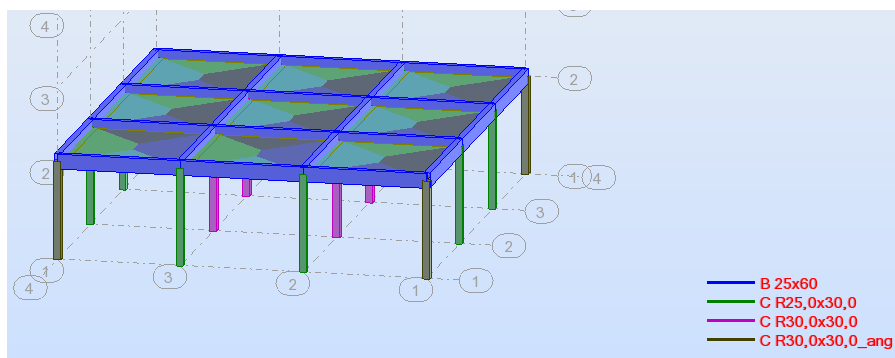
Modélisation en trois dimensions du premier bâtiment étudié.
